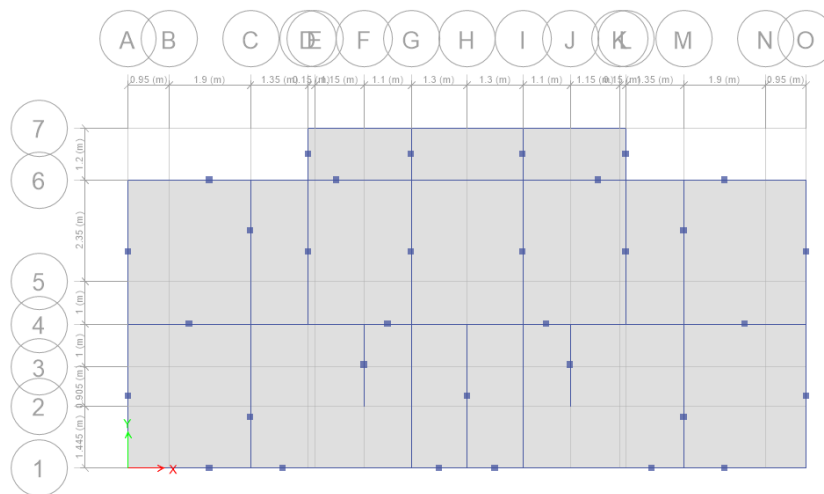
Perspectiva del modelo numérico en planta de las columnas anchas.
